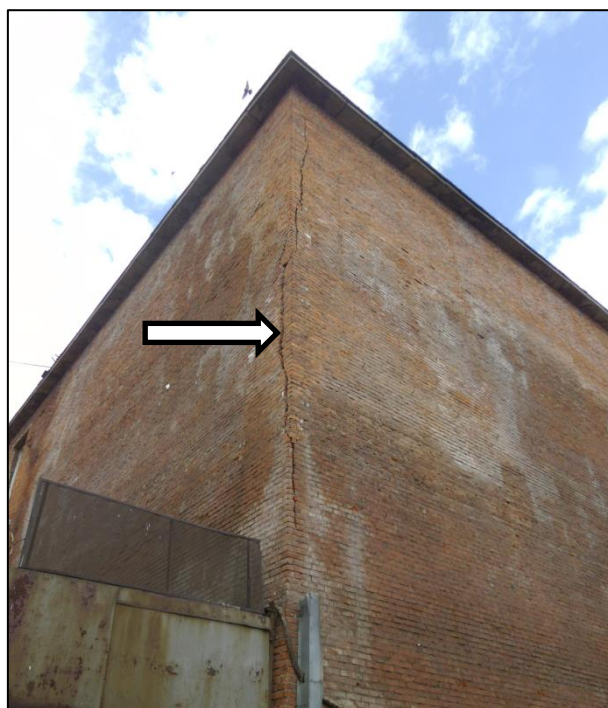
Сквозные вертикальные трещины в углах стен, образовавшиеся после утепления (снимок выполнен после демонтажа наружного утеплителя)
